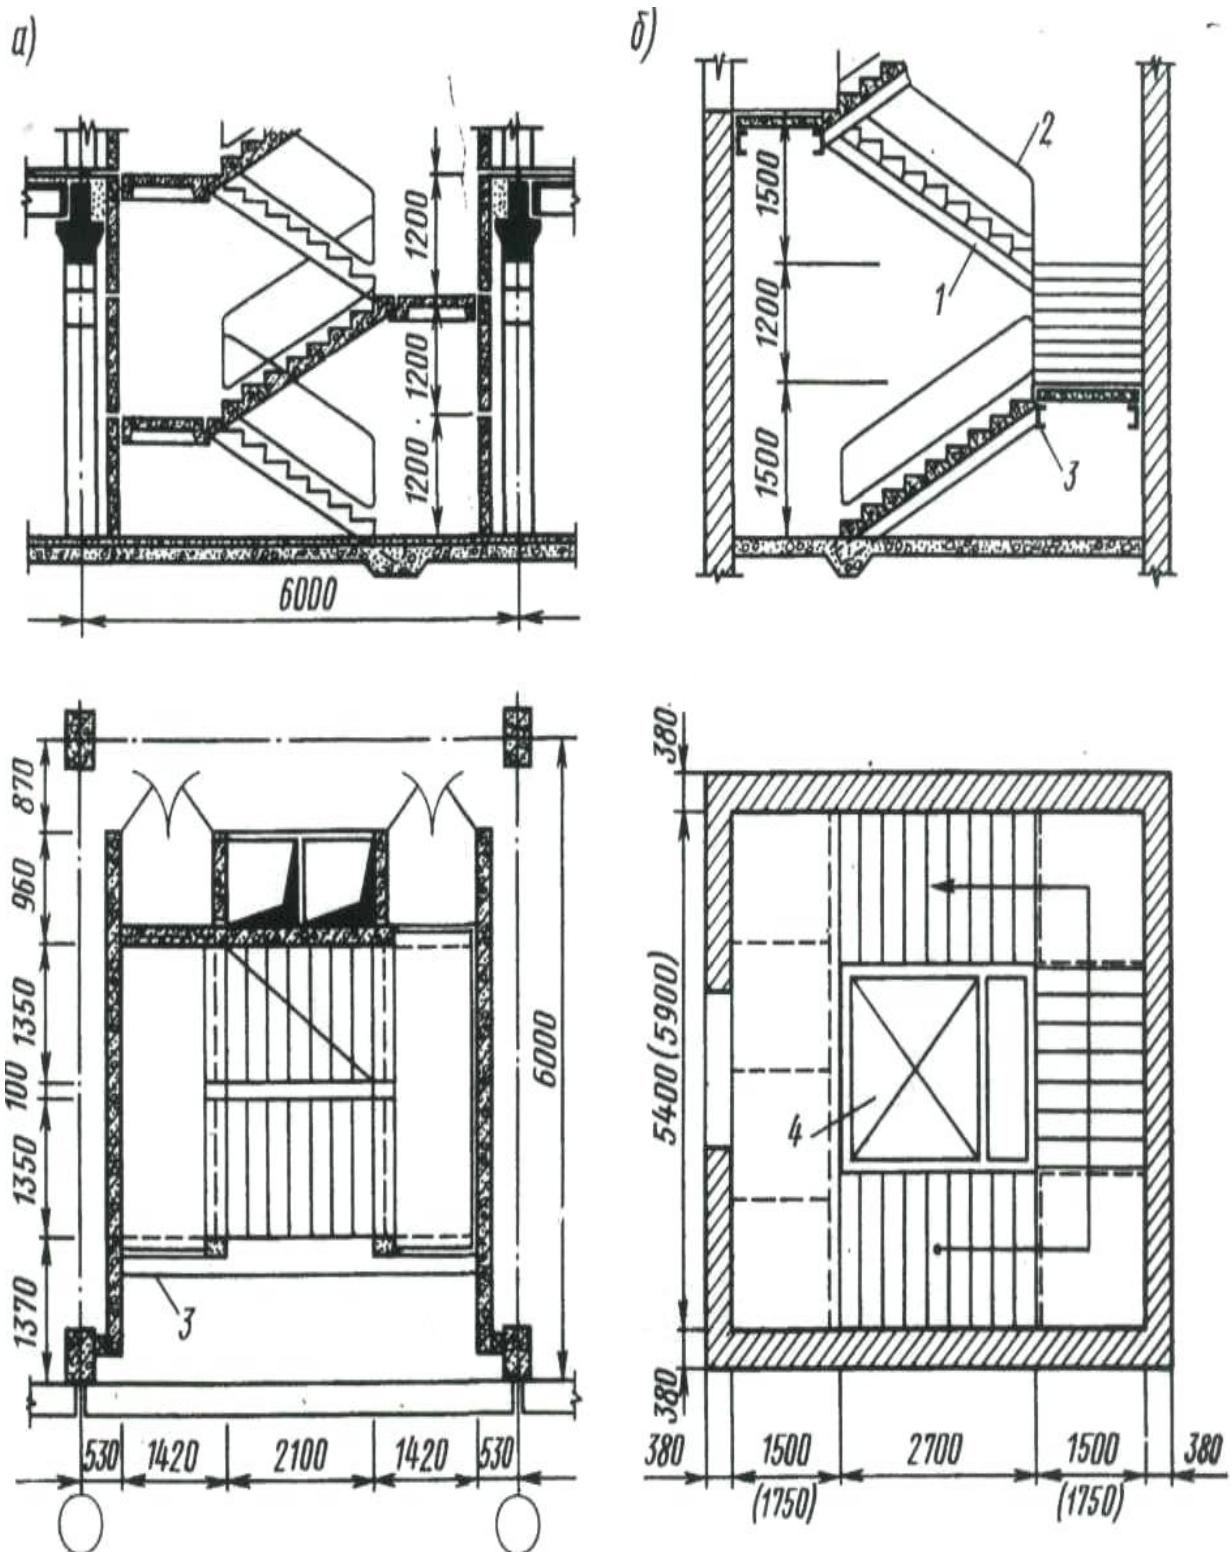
Основні сходи багатоповерхових будівель:
